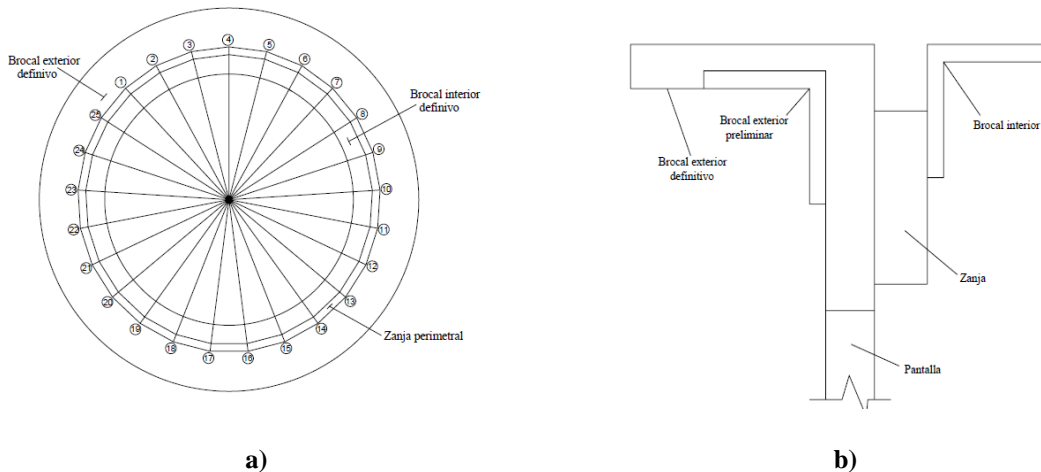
a) Trazado de brocales b) Excavación de zanja y muro pantalla (Orduño and Auvinet 2010).
